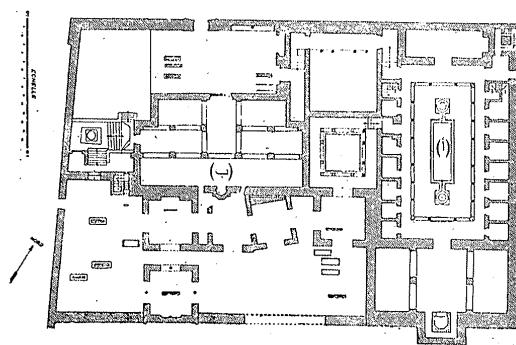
مسقط أفقى لمدرسة سيدي بو مدين المرينية
